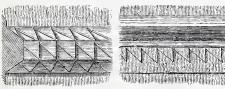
Sagezahnverzierung. Fig. 3057.
